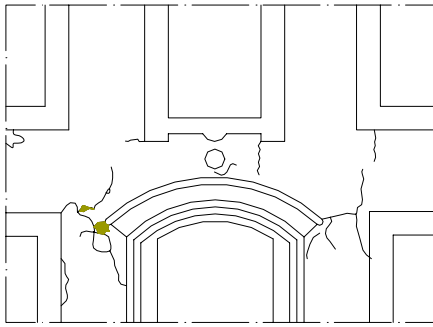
Fissuração junto aos cantos de janelas
